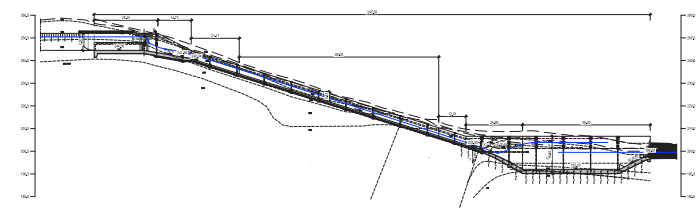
Perfil Longitudinal do Descarregador de Cheias. Flood Spillway Longitudinal Profile.
